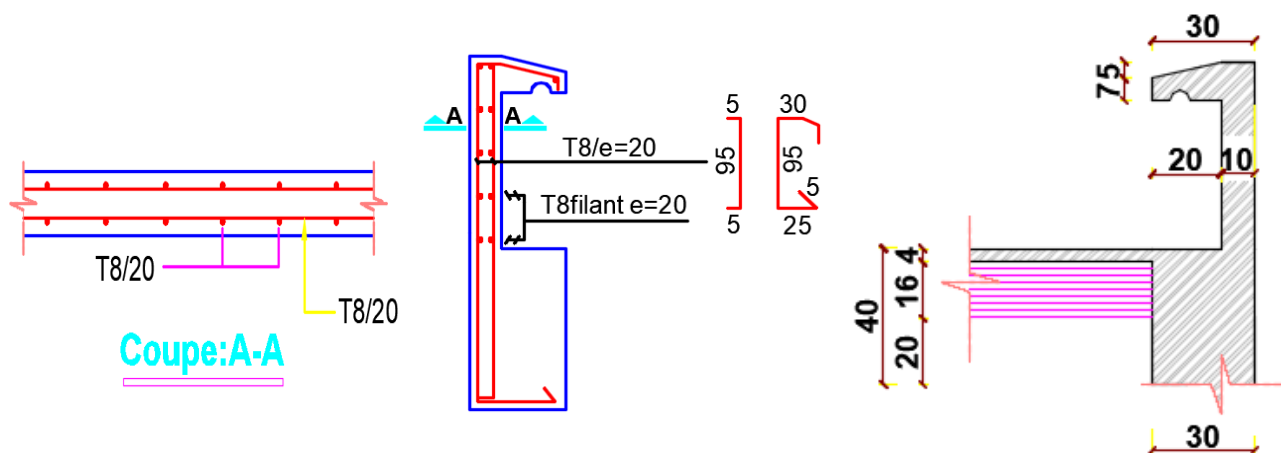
Schéma de ferrailage et coffrage de l'acrotère
